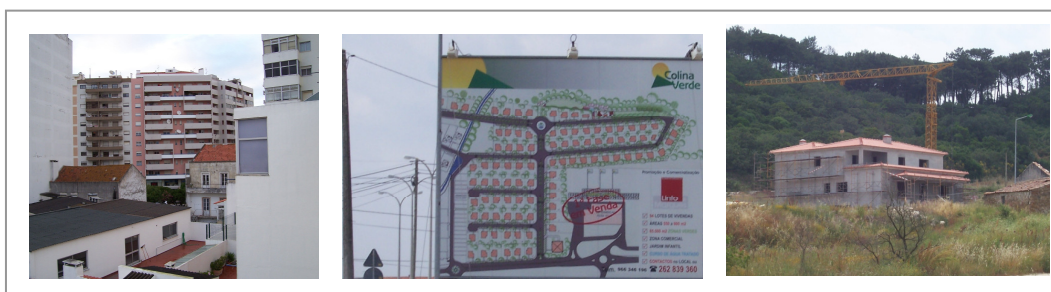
Vista para a Avenida 1º de Maio (centro);
